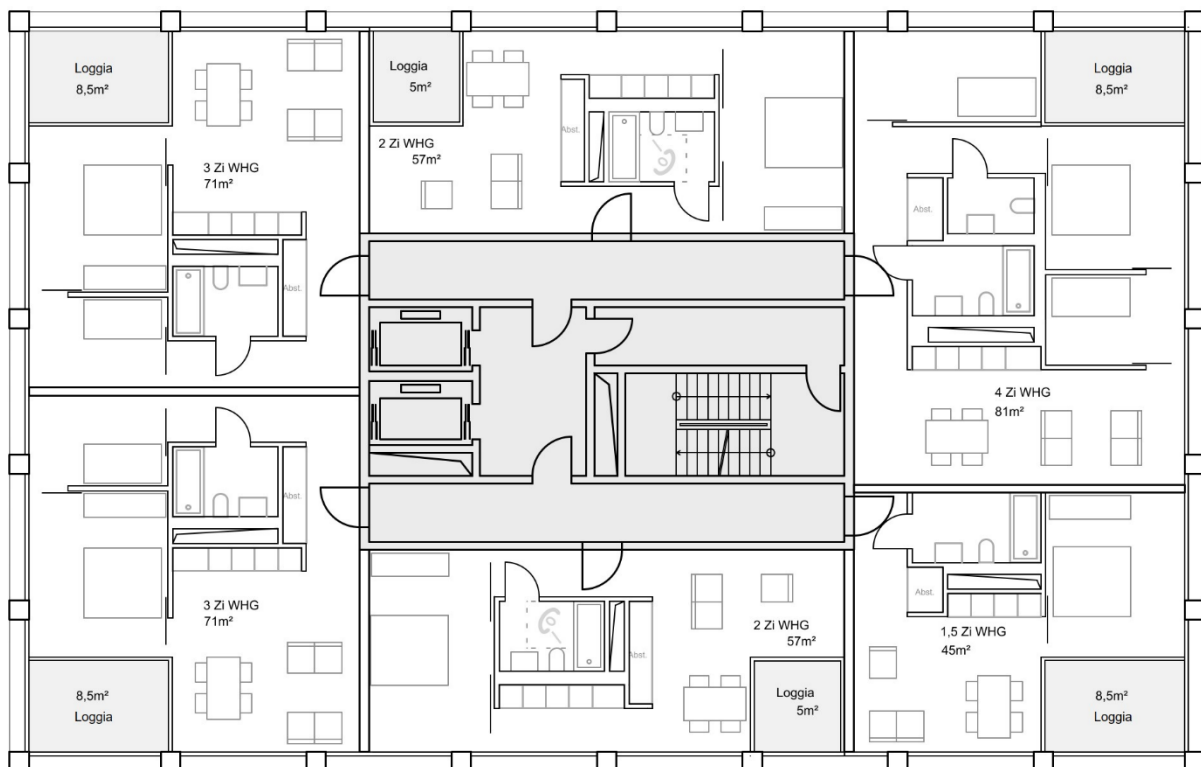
| Quartier 10 - Hochhaus: möglicher Grundriss eines Wohngeschosses
